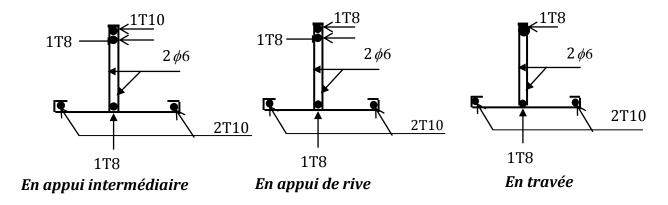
Schémas de Ferraillage des Poutrelles de la terrasse accessible
